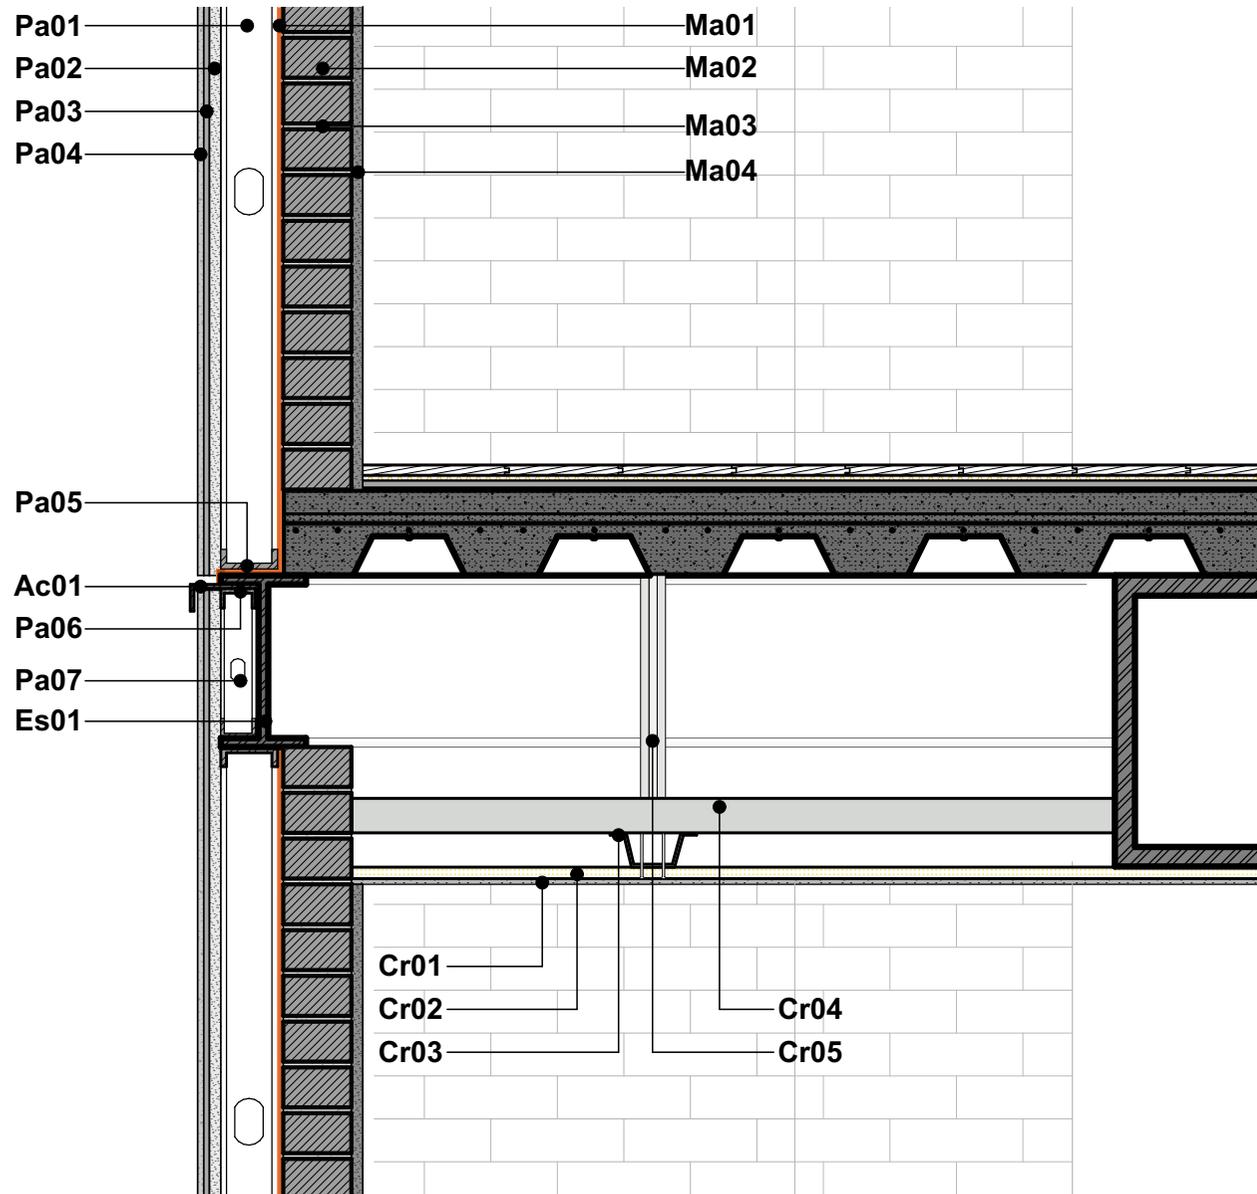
Detalle constructivo. Fuente: Elaboración propia
